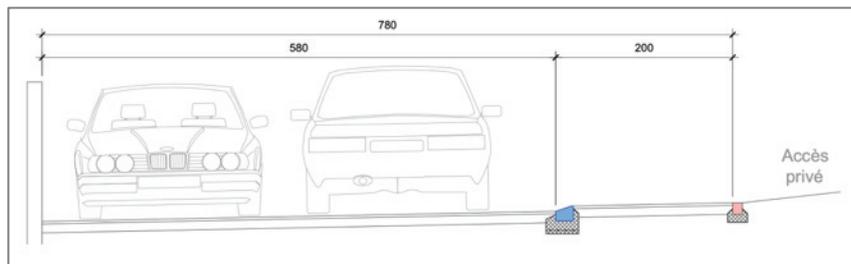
secteur I – gabarit au droit des accès privés (extrait du plan des surfaces MCR)
